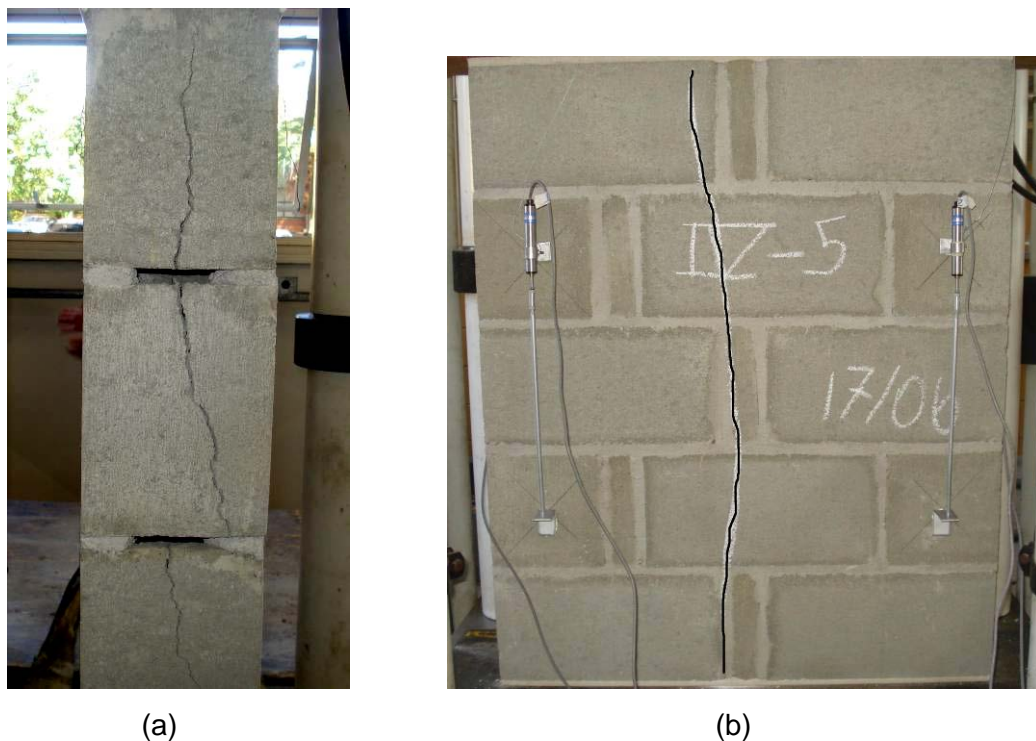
Vista lateral (a) e vista frontal (b) da mini-parede com argamassamento lateral com rapaduras (Série IV)
